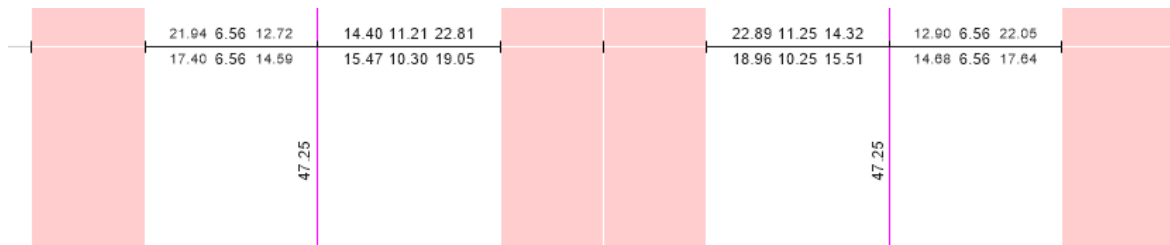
Acero Requerido por momentos en Vigas 2° Piso
